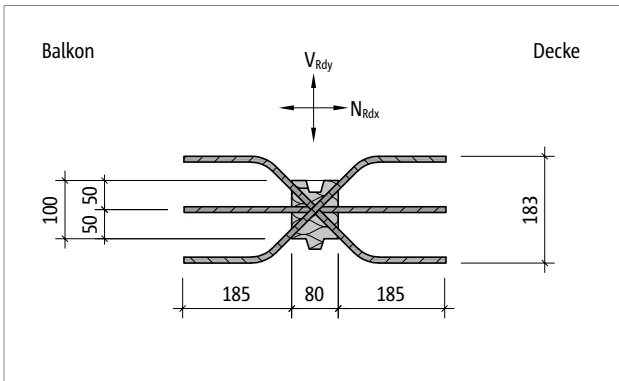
Schöck Isokorb® T Typ H-VV1-NN1: Produktgrundriss
